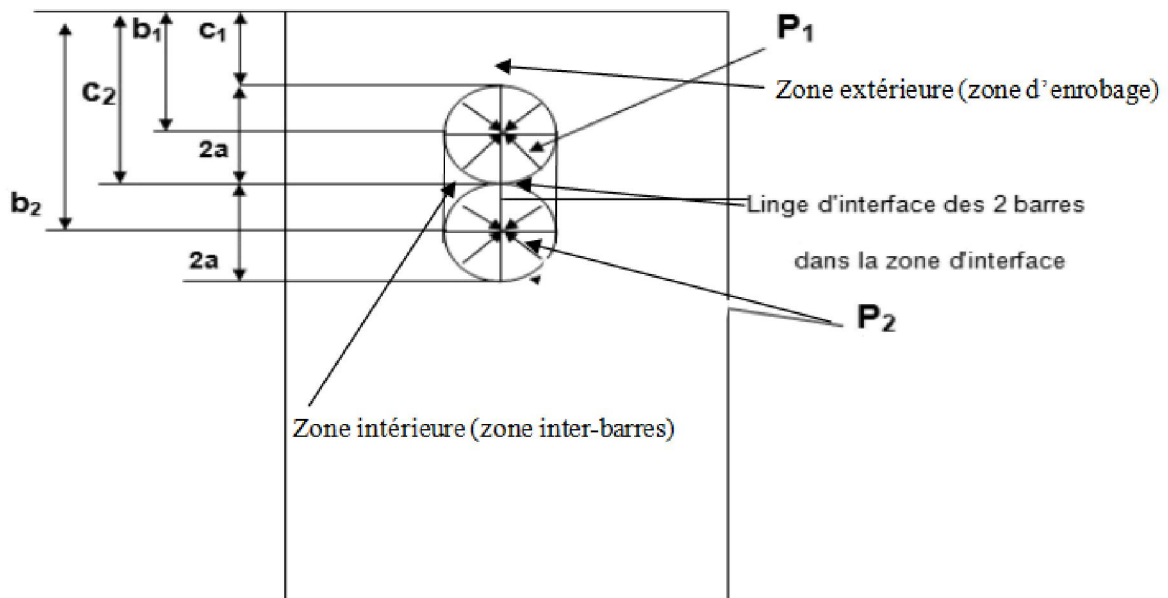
Section d'une Poutre prismatique en béton armé de deux barres en PRF.
